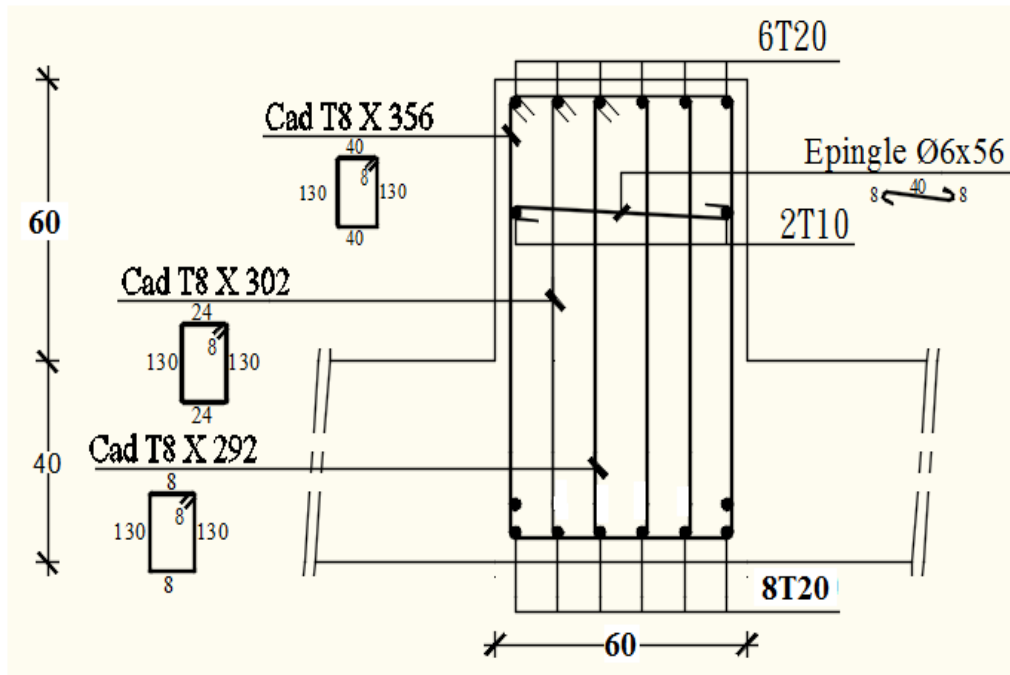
dessin de ferrailage d'une poutre principale en appuis.
